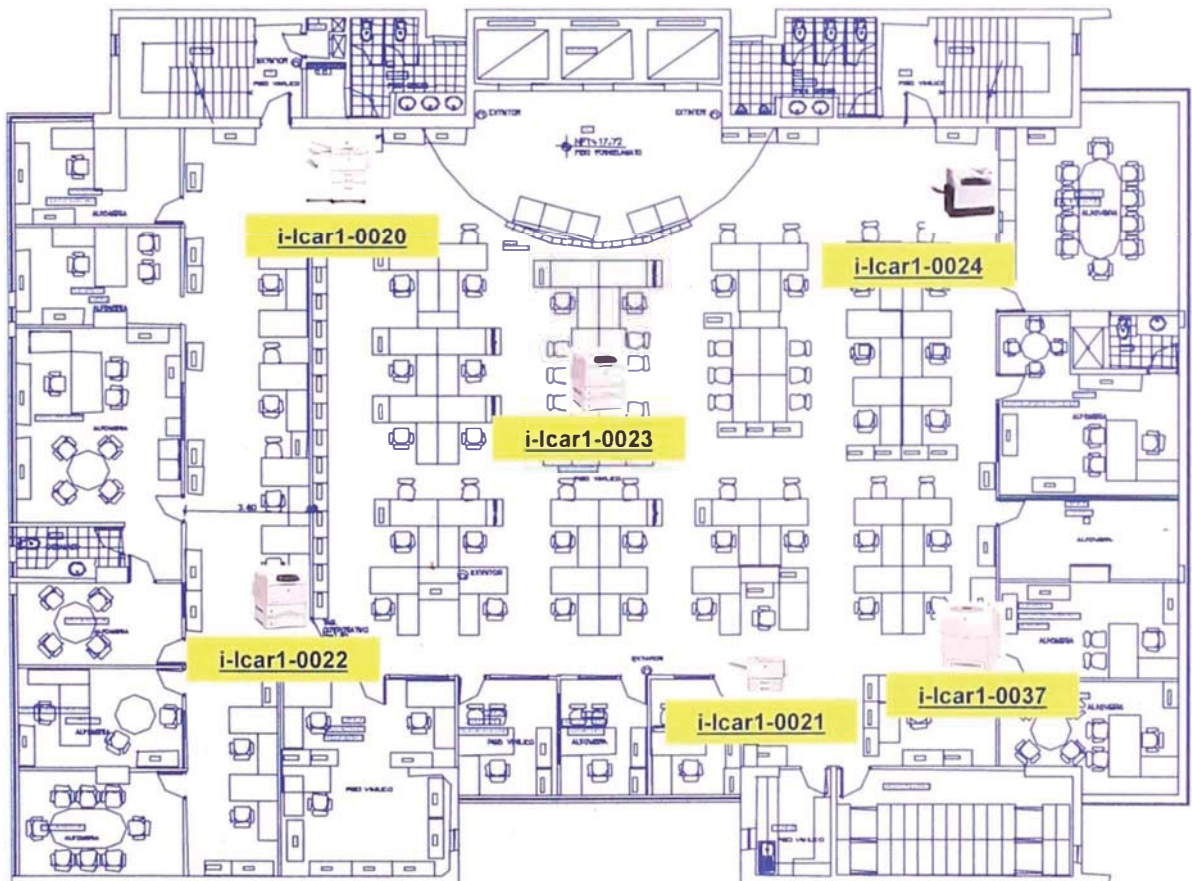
Plano de distribución de impresoras del Piso 6 – Local Av. Arequipa.
